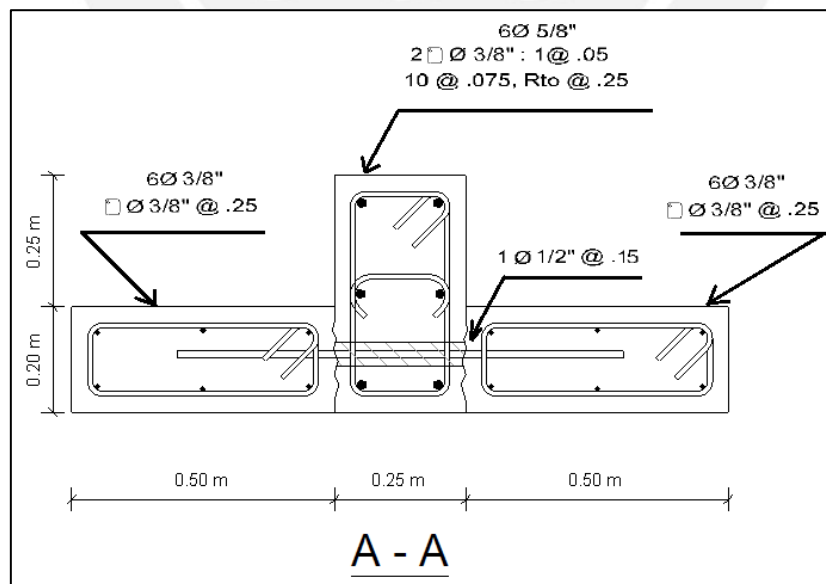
Detalle del reforzamiento con aletas de concreto en las columnas
